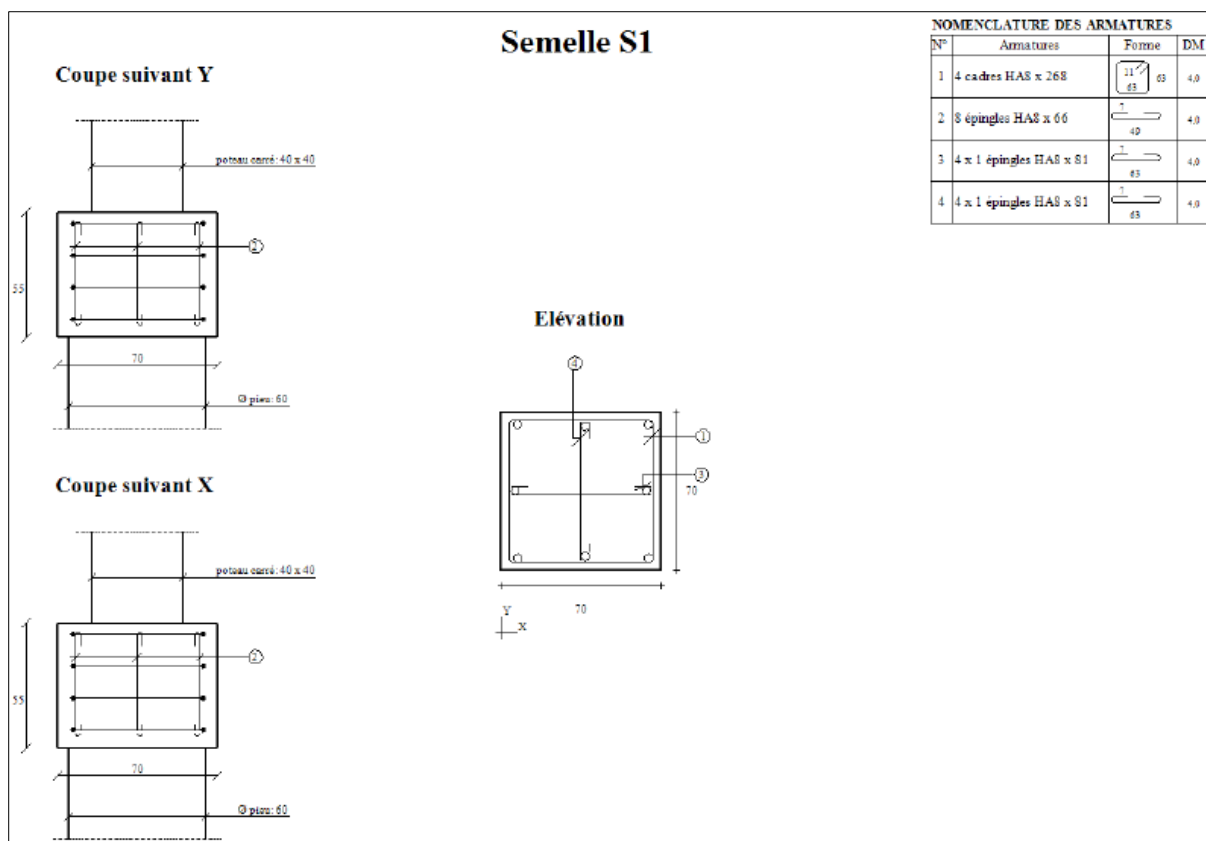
Présentation du ferrailage par le logiciel Semelle BA sur pieux™
